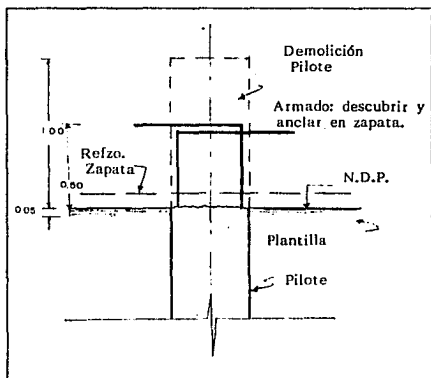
ANCLAJE DE PILOTE AL CAJON
